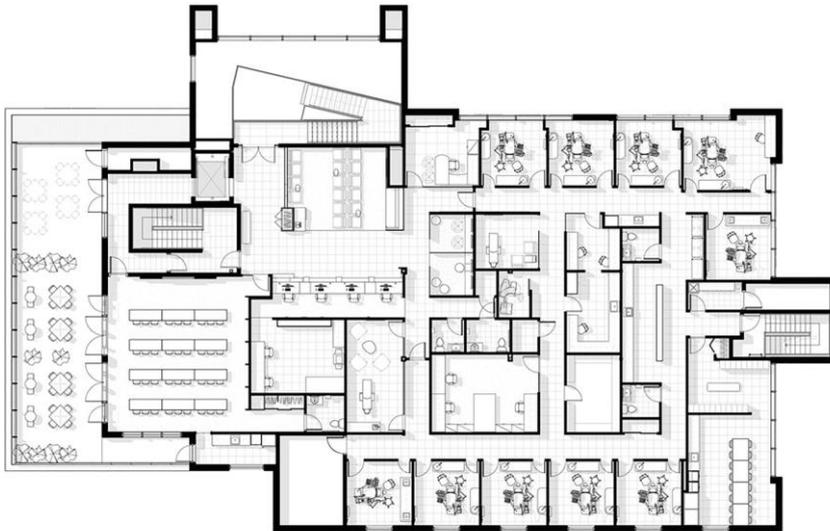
Planta baixa Clínica Le 1650, Laval, QC, Canadá.
